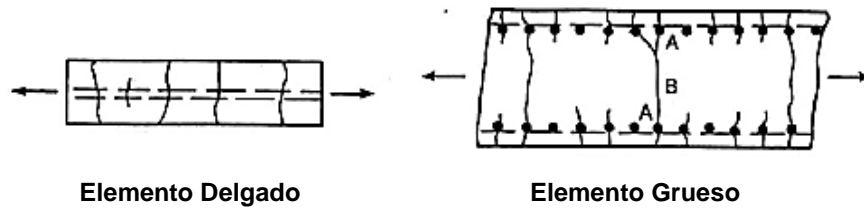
Grietas por esfuerzo de Tracción Diagonal
